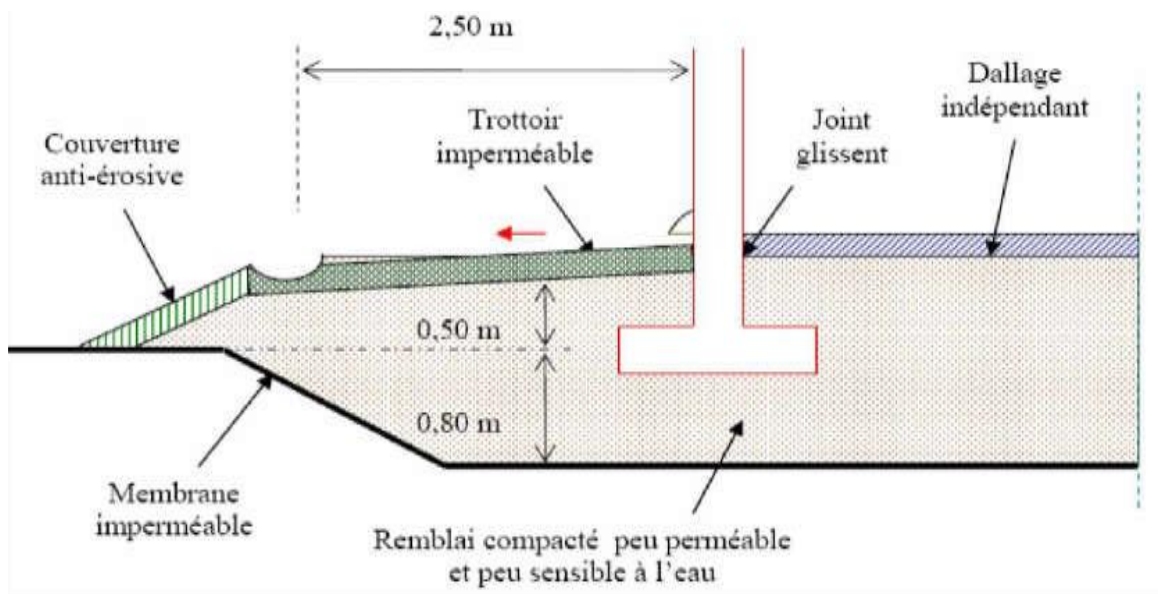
Semelles superficielles sur remblai (Ferrah, 2006).
